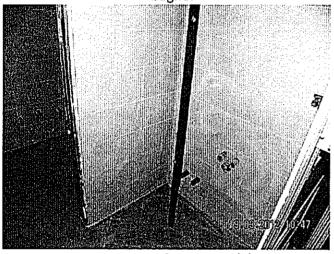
Bagno (7)- Vista interna- piastrellato ed impianti posati
